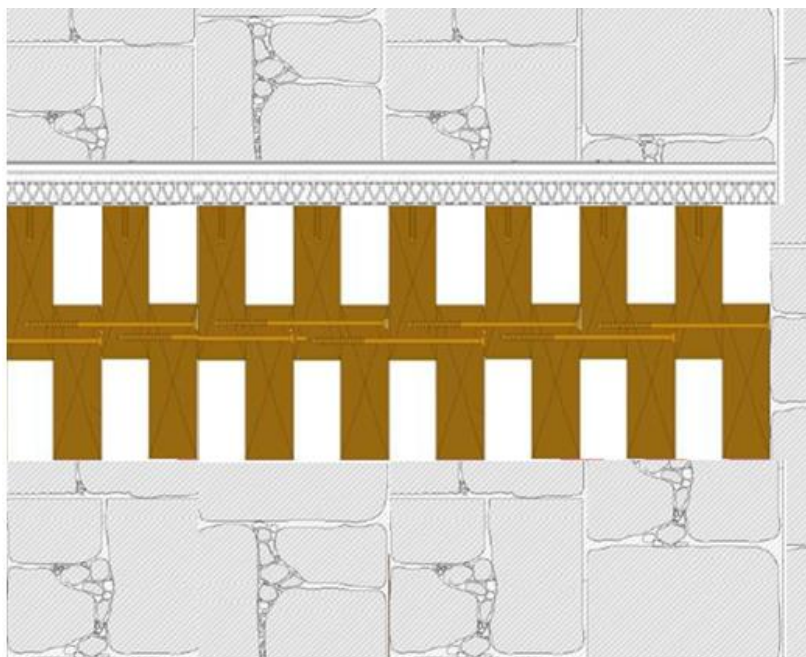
Corte pormenorizado da solução pré-fabricada do sistema "O'Portune" (Autoria própria)
